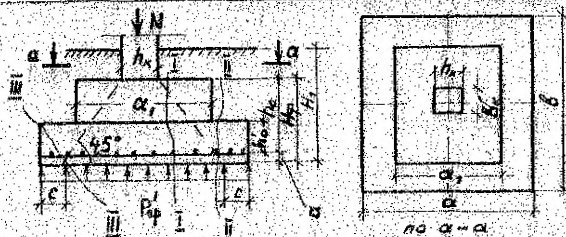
РАСЧЕТНАЯ СХЕМА ФУНДАМЕНТА.
